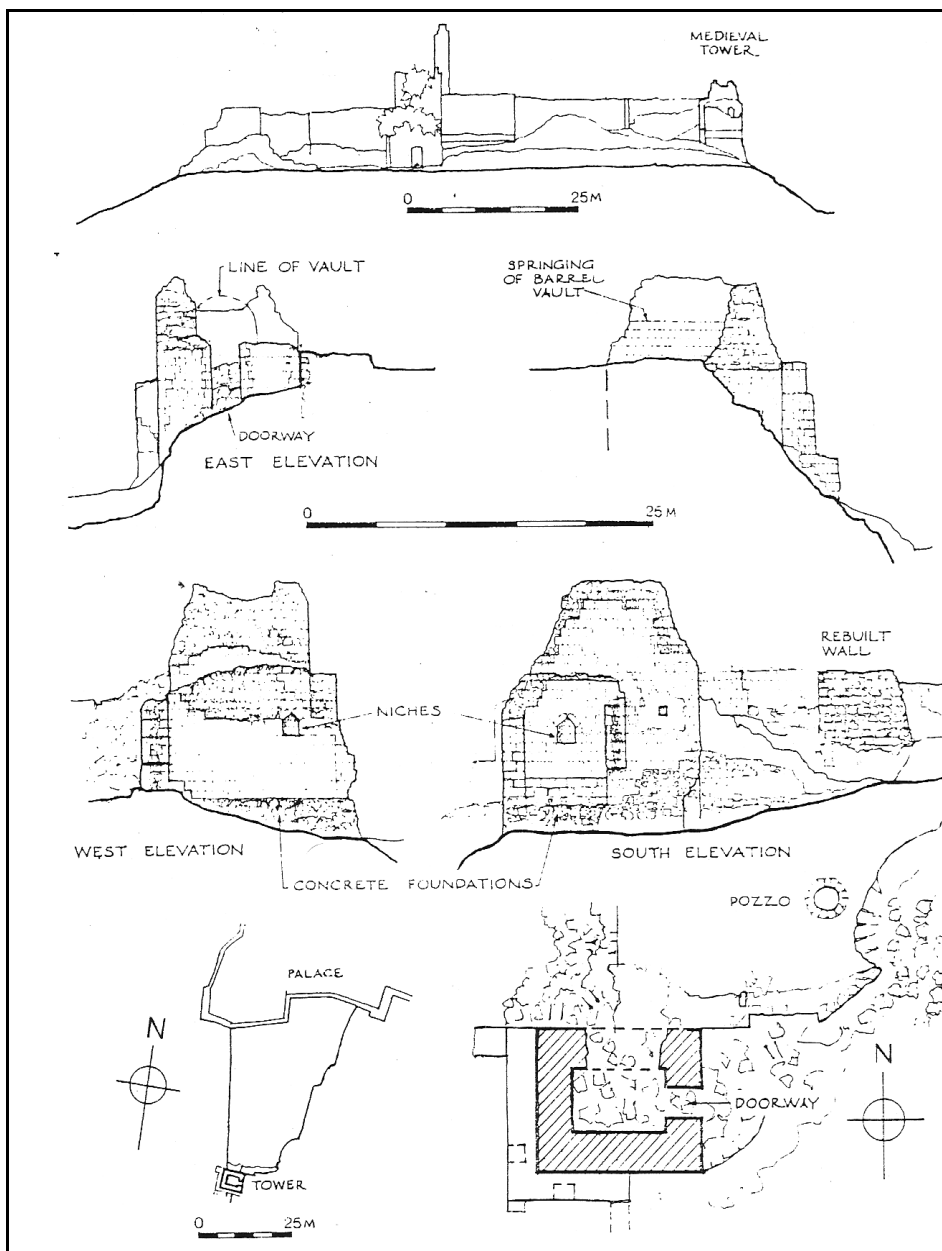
Rilievi di S. Gibson (alzato e pianta della torre quadrata dello sprone).
